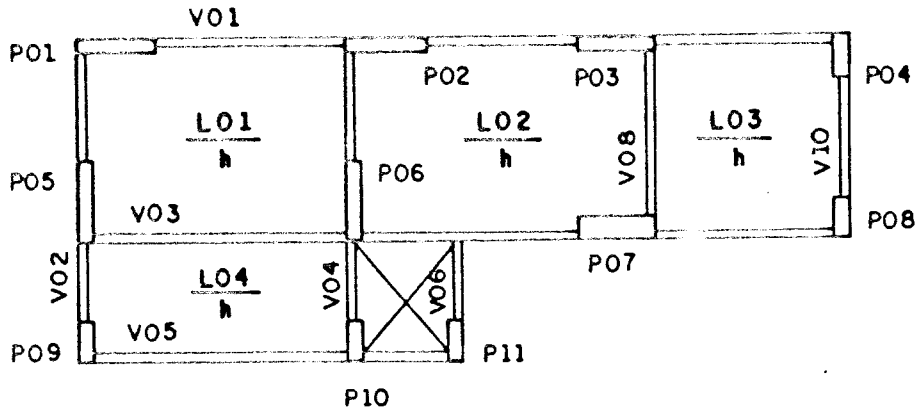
Forma do pavimento vigas, pilares, lajes e "buracos"
